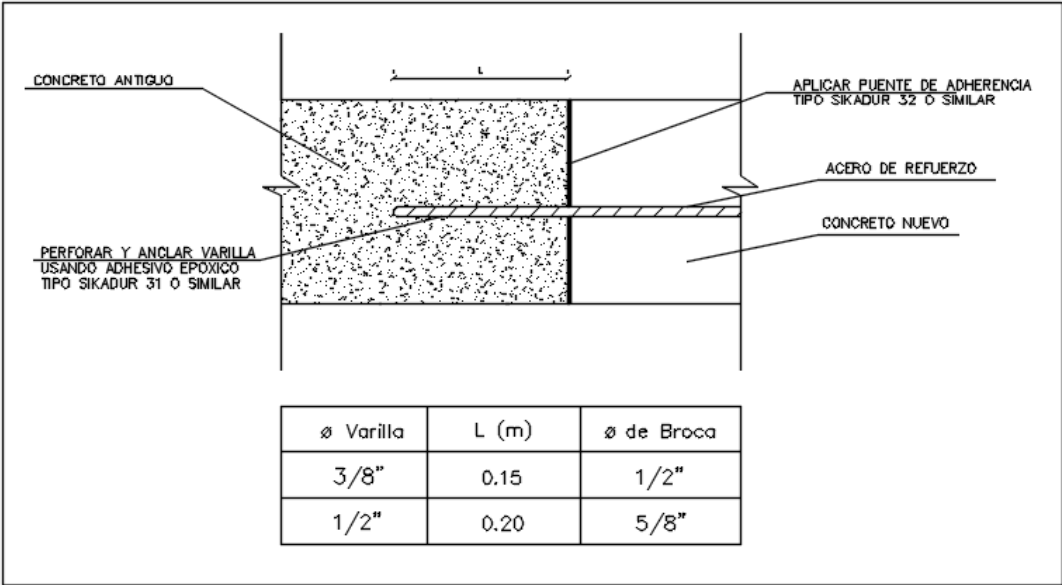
Anclaje típico de refuerzo proyectado en concreto existente
